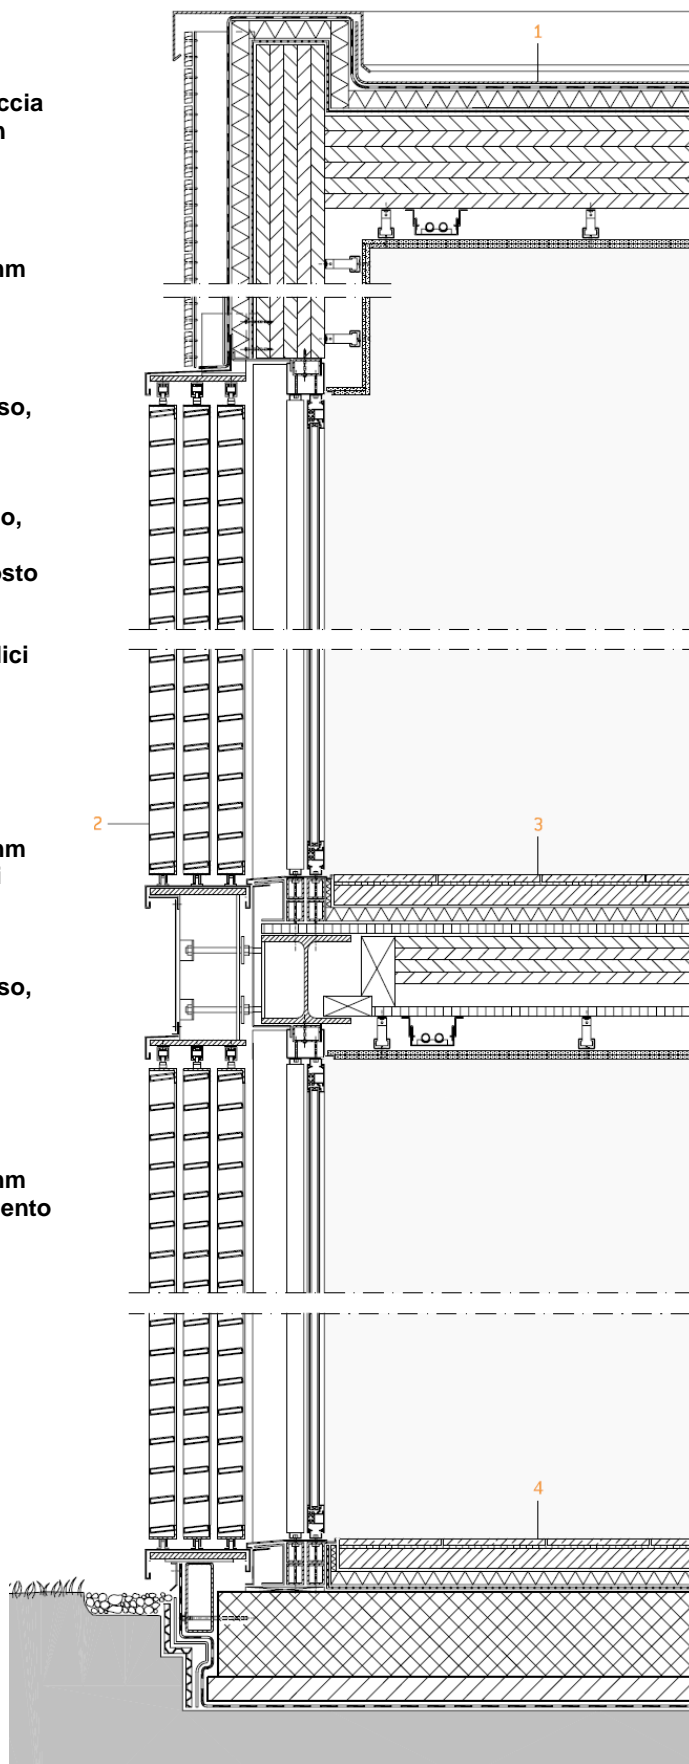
Sezione verticale del nuovo edificio in scala 1:20
